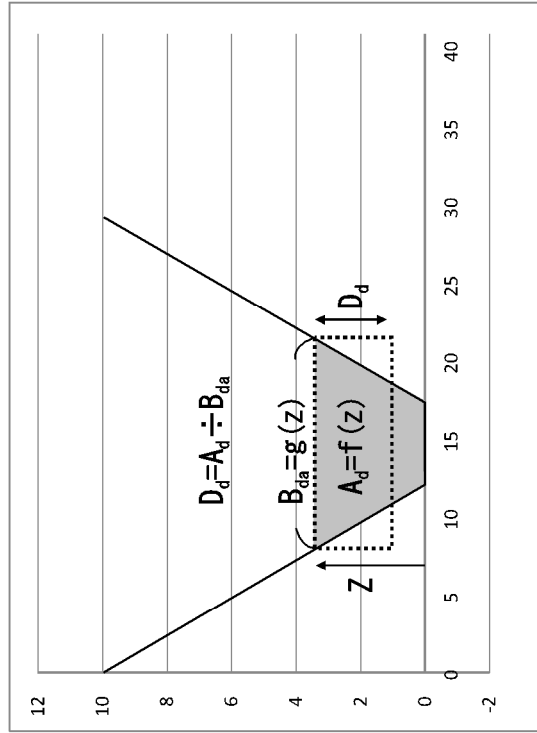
砂防堰堤計画地点上流の渓流横断面図
